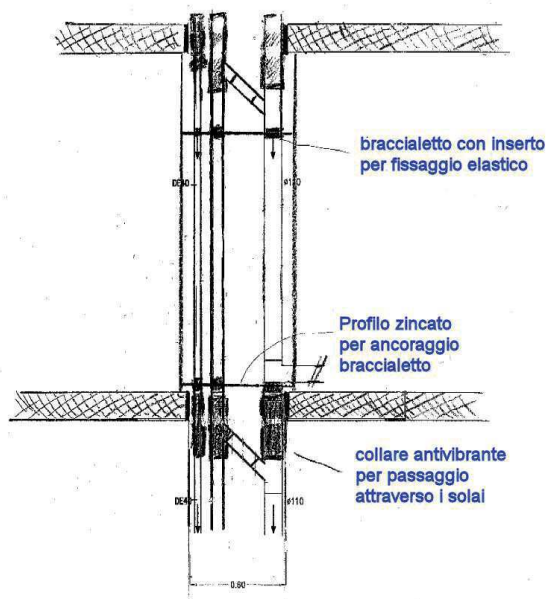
Passaggio delle tubazioni tra piani sovrapposti
